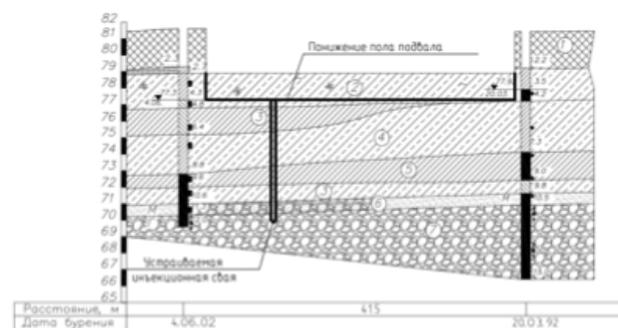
Инженерно-геологический разрез площадки и схема посадки здания и инъекционных свай усиления (ООО «НТФ Геостройпроект», 2003 г.)
